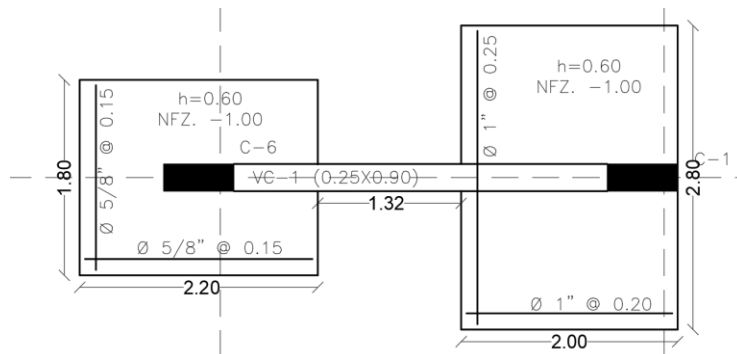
Diseño estructural de Zapatas conectadas de columnas C-6 y C-1
